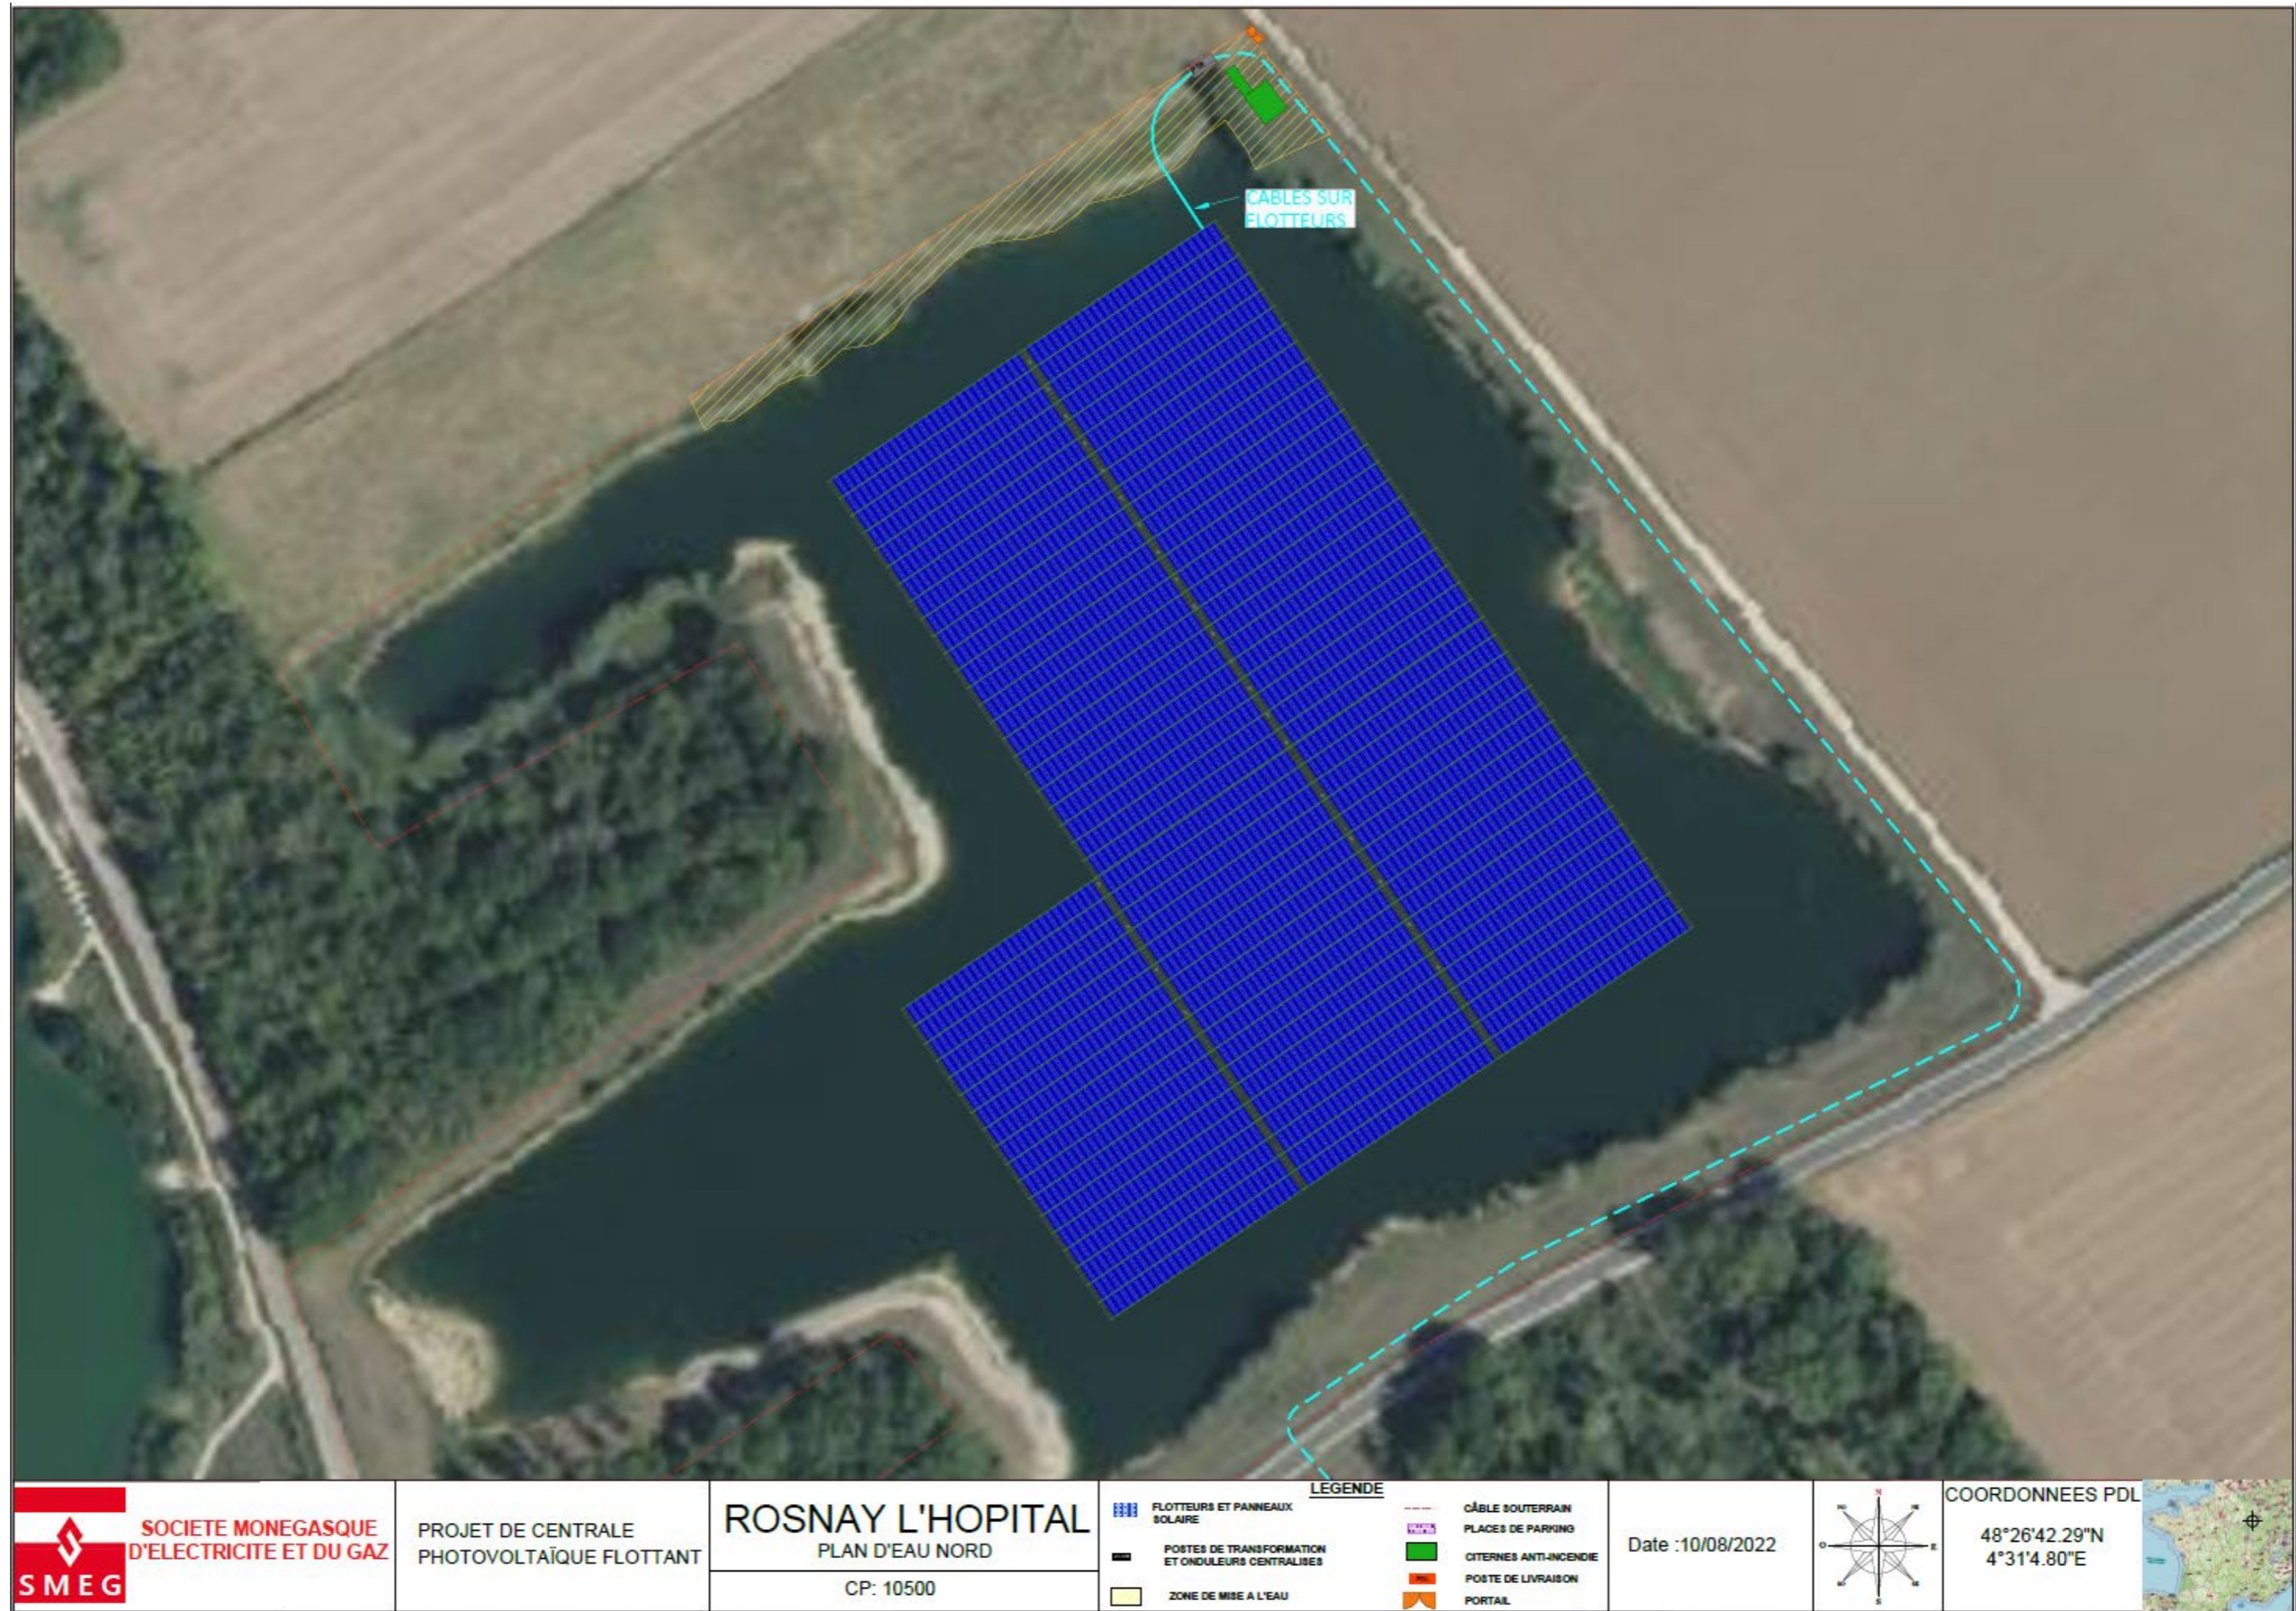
Plan de masse de la centrale Nord (plan d'eau Nord) (Source : SMEG)
